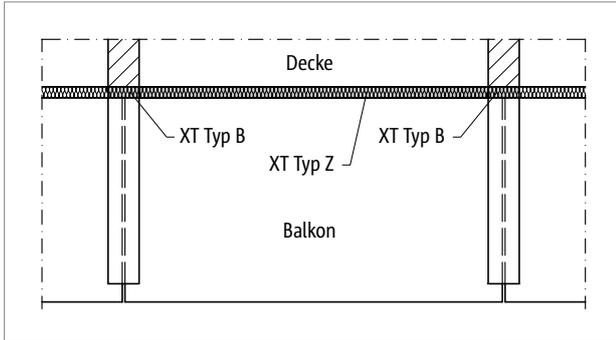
Schöck Isokorb® XT Typ B: Balkonkonstruktion mit frei auskragenden Unterzügen (Fertigteilbalkon)
